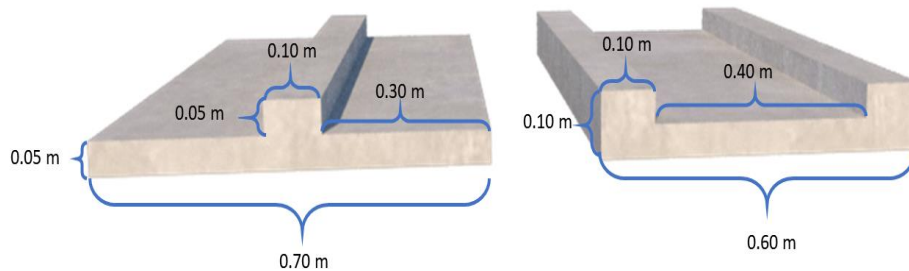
Prototipo A de los paneles prefabricados propuestos (Elaboración propia)
